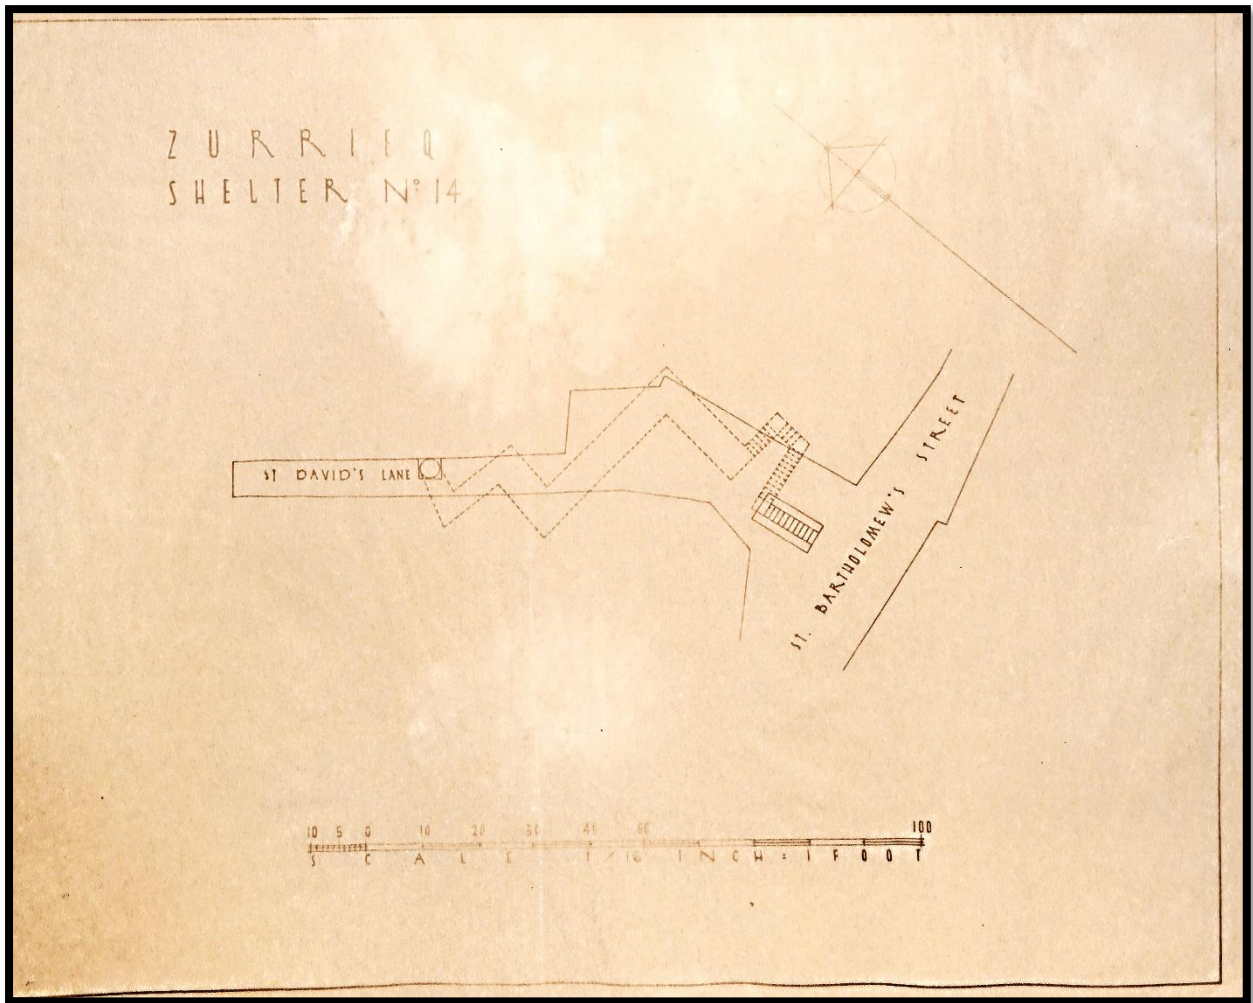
Planta do Abrigo nº14 "St. Davi's Lane – St. Bartholomew's Street."
